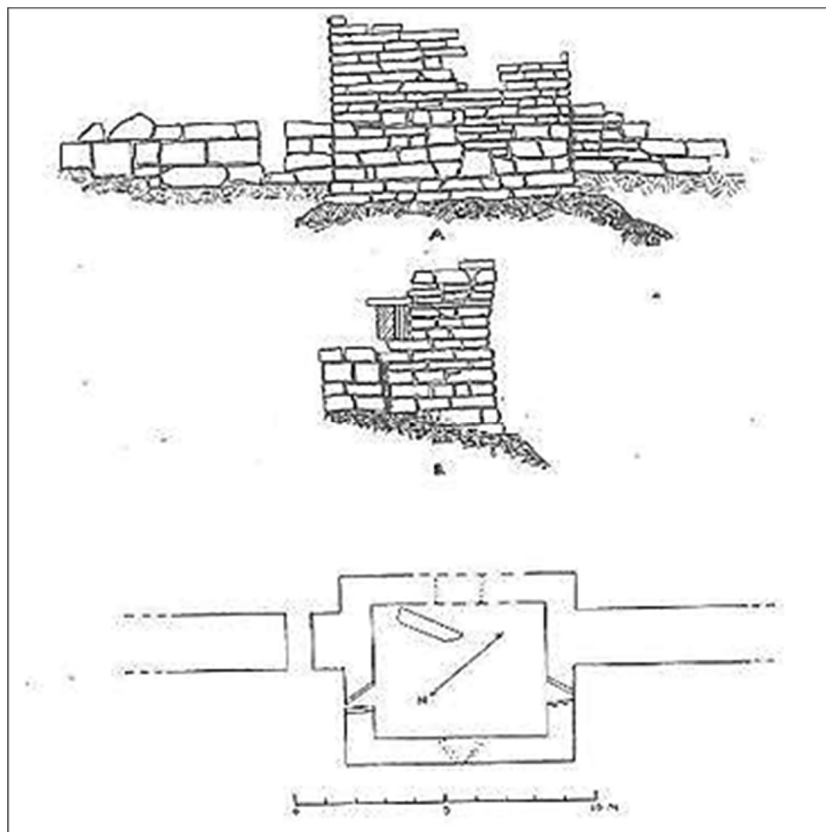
Plan et relevé pierre à pierre du tronçon de rempart nord-ouest conservé
